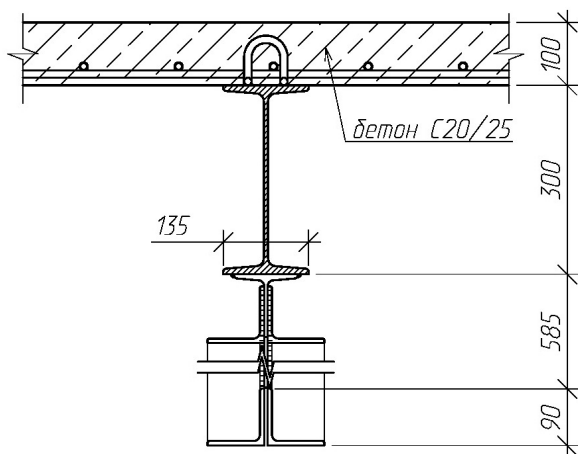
Переріз шпренгельної сталезалізобетонної конструкції перекриття після бетонування, прольотом 10 м.
